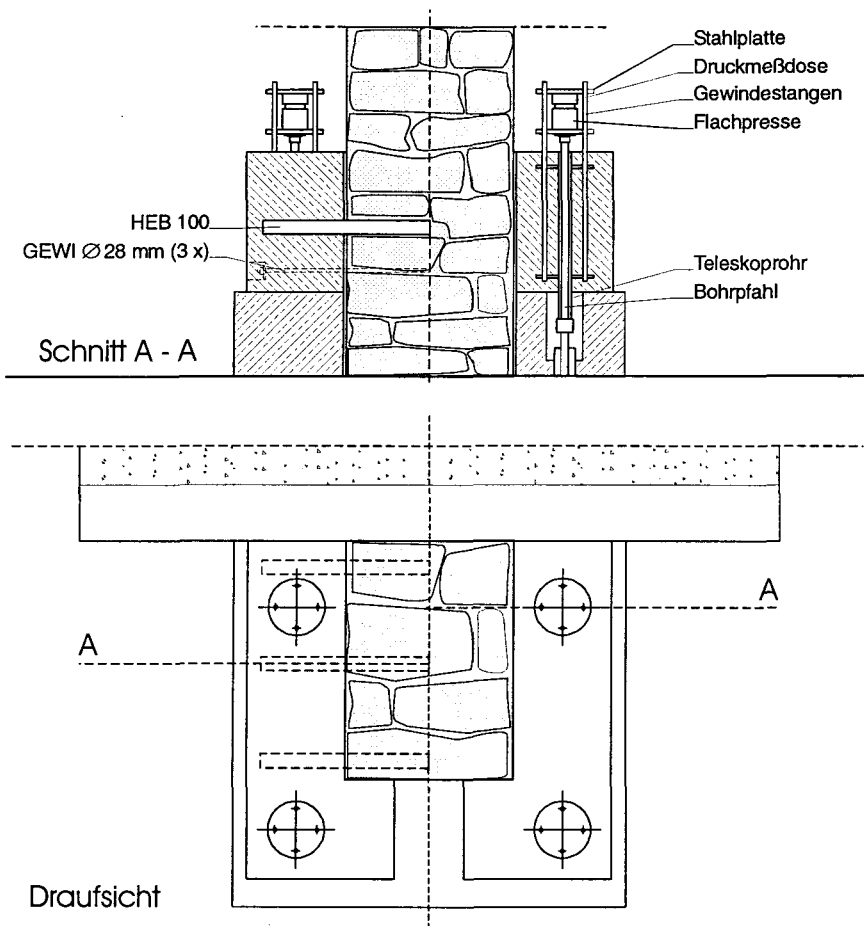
Stahlbetonkonstruktion zum Lastabtrag
